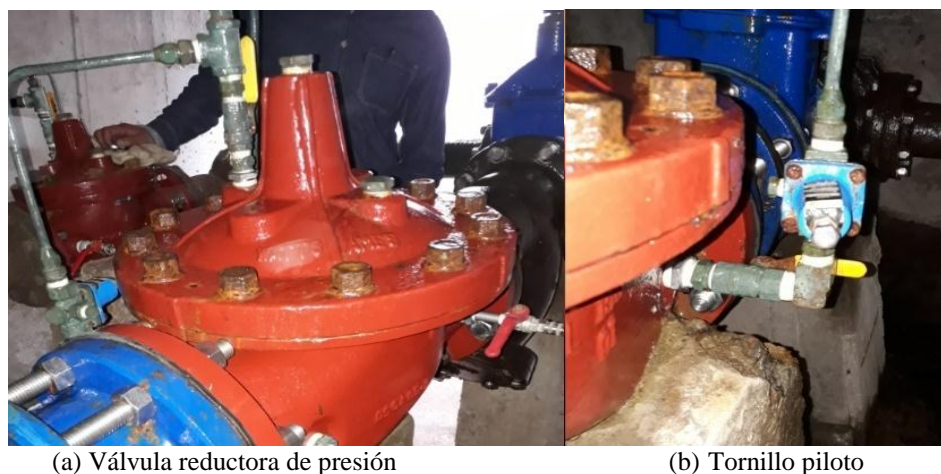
Conjunto Válvula reductora de presión y tornillo piloto
